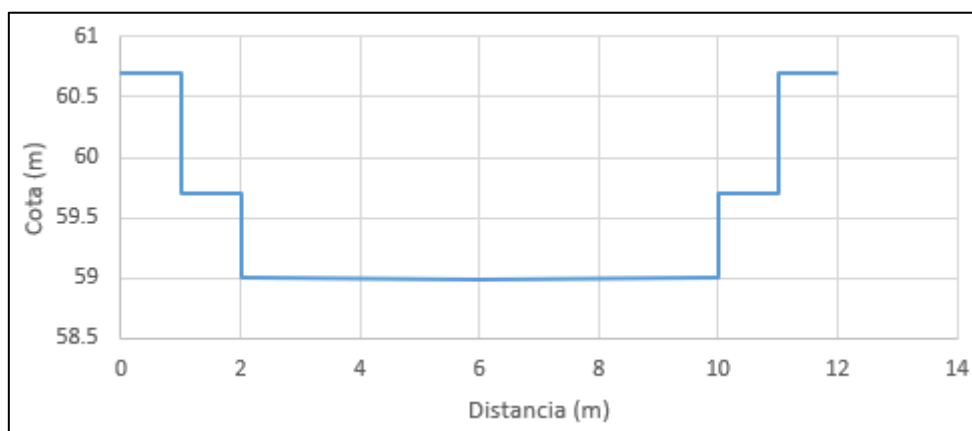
Sección transversal utilizada para el desagote de la Laguna Yrupe
